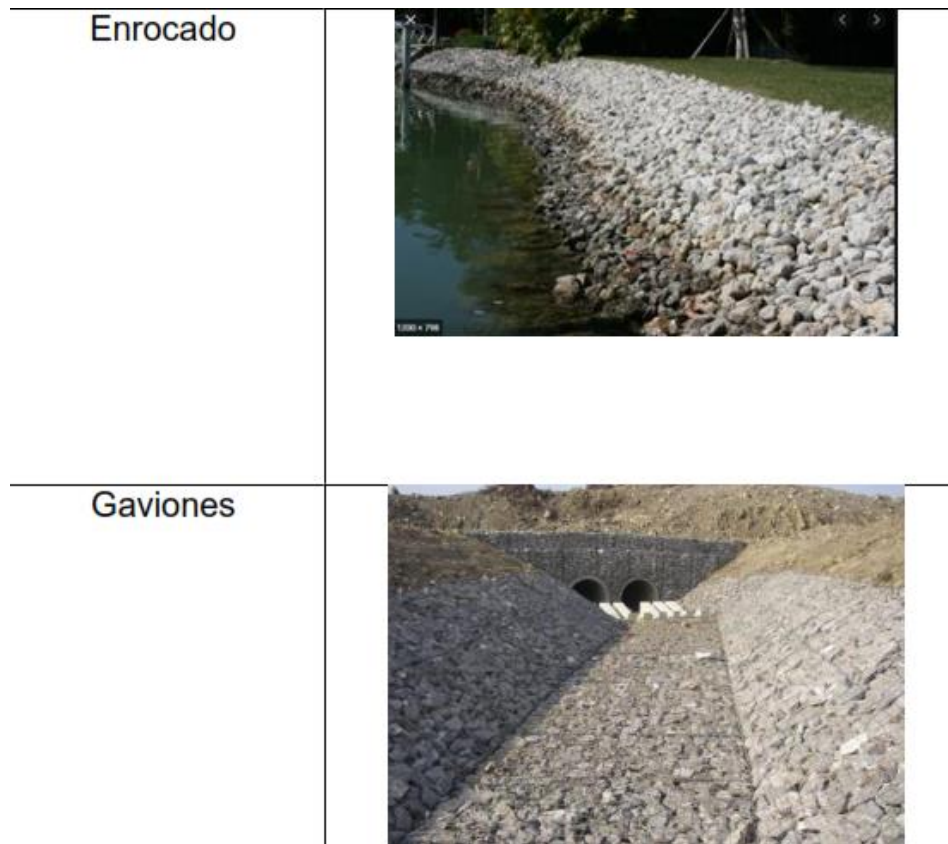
Enrocado y gaviones para revestimiento de canal del arroyo Palo Verde.
